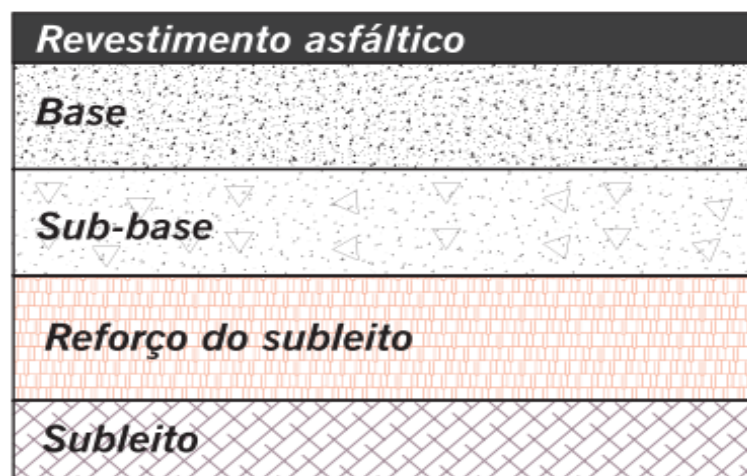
Estrutura de pavimento flexível. Fonte: (Bernucci, 2008).
